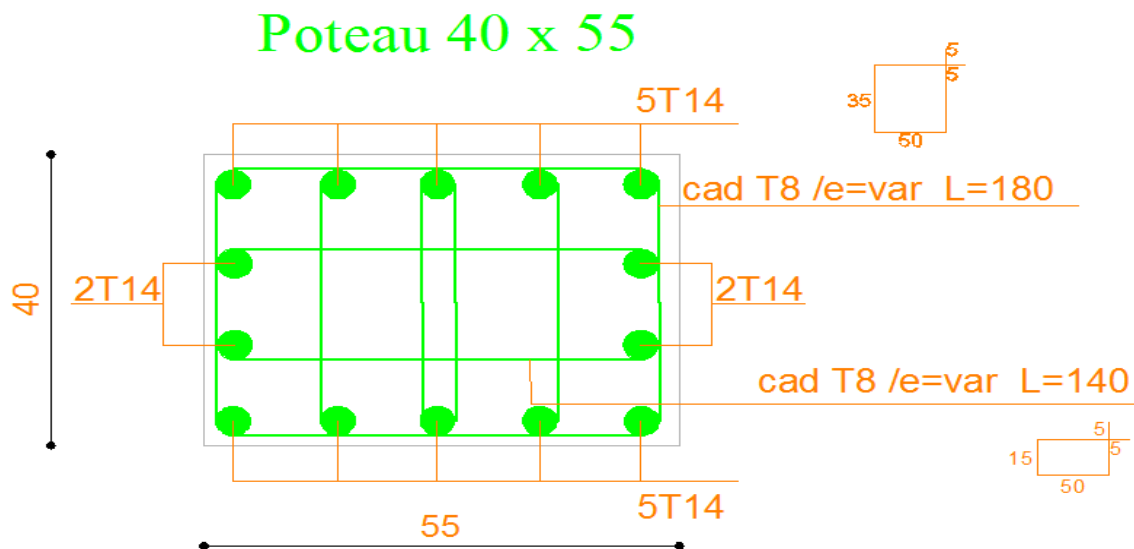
Schéma de ferrailage des poteaux 40x55.
